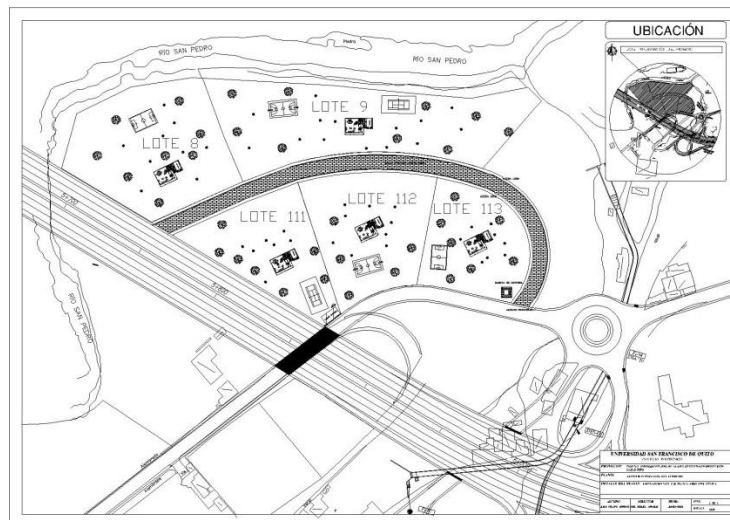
, Lotización con Emplazamiento de P.B. Planta Arquitectura y Canchas
